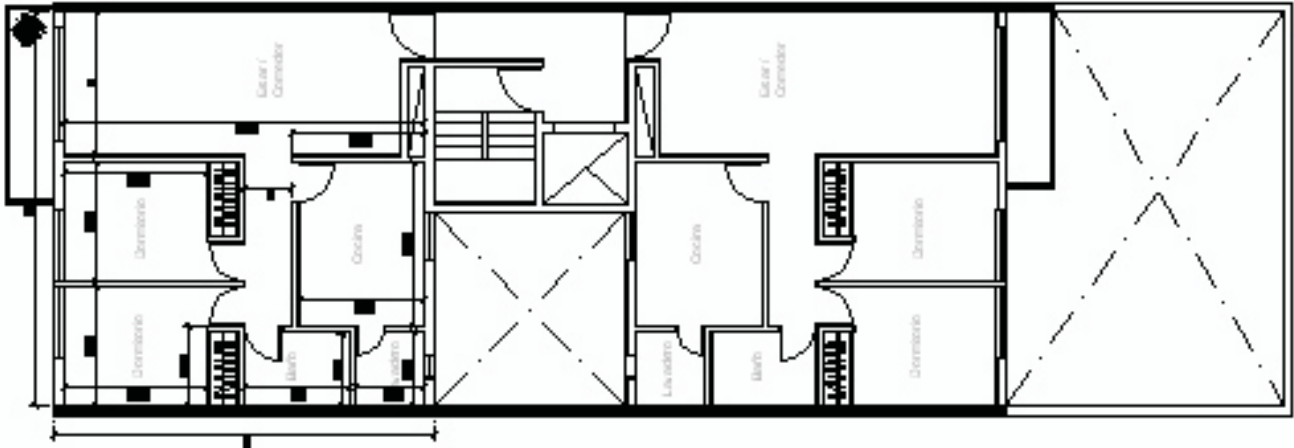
Planta de vivienda tipo “Hogares Departamentos”
